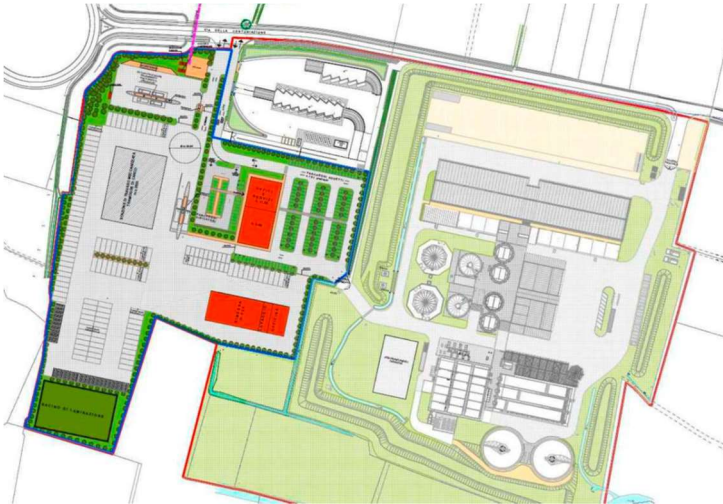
Planimetria generale del nuovo polo logistico di Rubano
